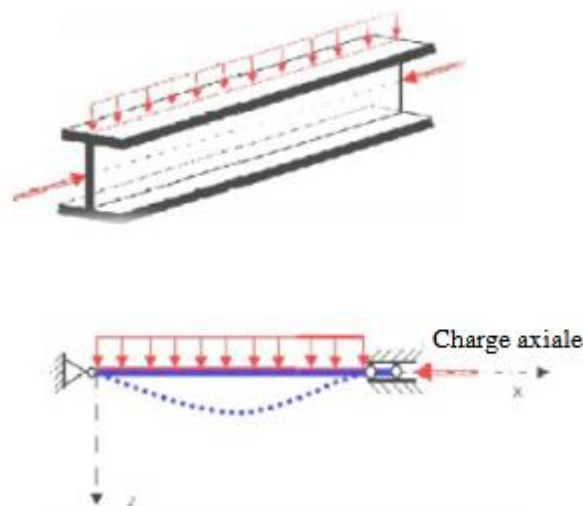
poteaux sollicités à la compression et à la flexion.
